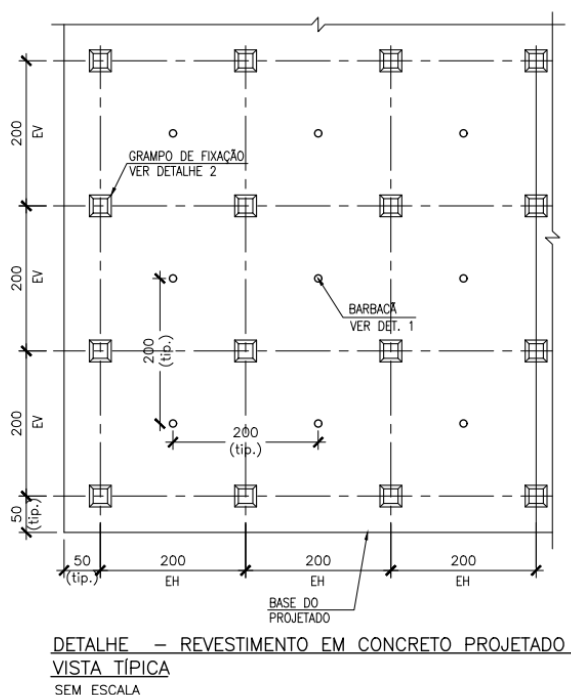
Detalhe típico espaçamento dos grampos do concreto projetado.
